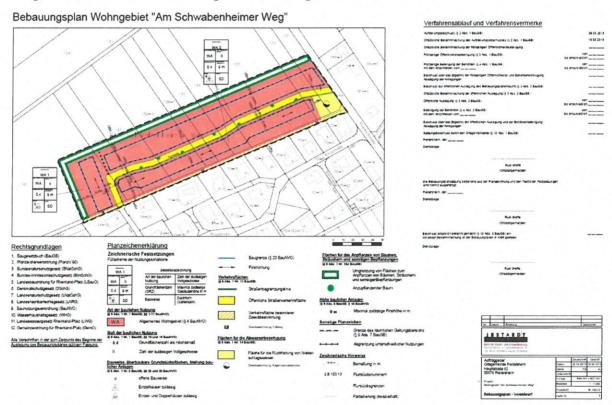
Bebauungsplan – Entwurf Planungsbüro; Jestaedt + Partner; Mainz
